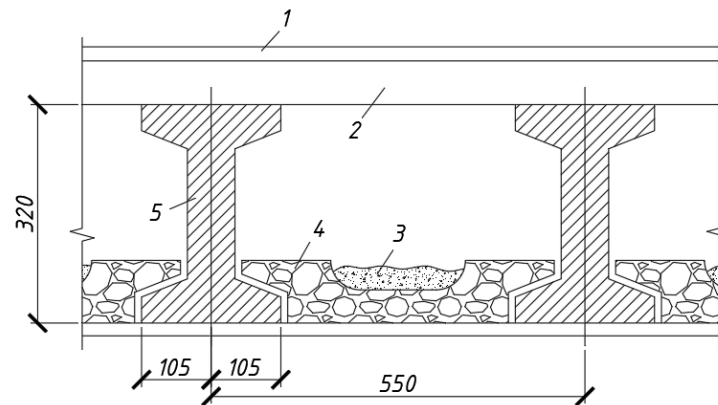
Конструкції для заміни перекриттів з залізобетонними прогонами швеллерного типу: 1 - дерев'яна підлога; 2 - дерев'яні лаги; 3 - утеплювач; 4 - легкобетонна плита-вкладиш; 5 - залізобетонний прогон швеллерного типу
